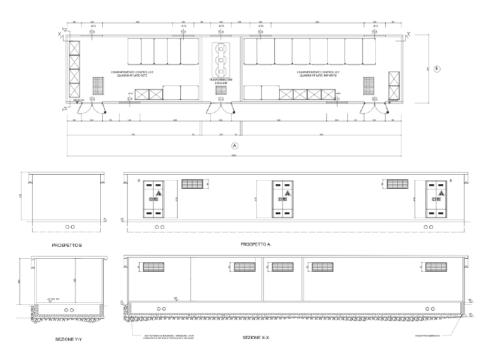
Cabina MT di smistamento - Vista in pianta e prospetto
